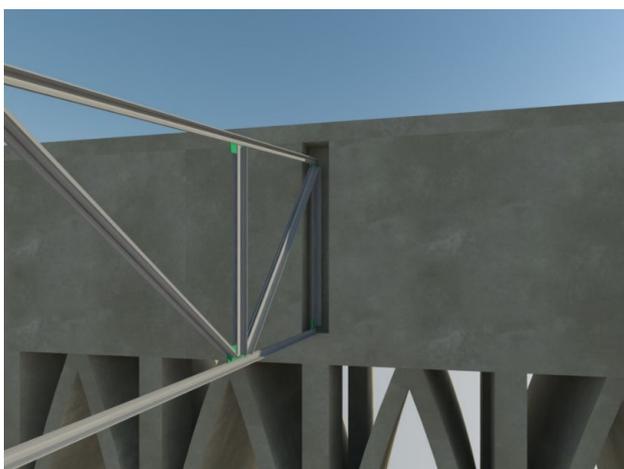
Detalhe do apoio da treliça metálica no modelo virtual. Fonte: acervo particular dos autores.
